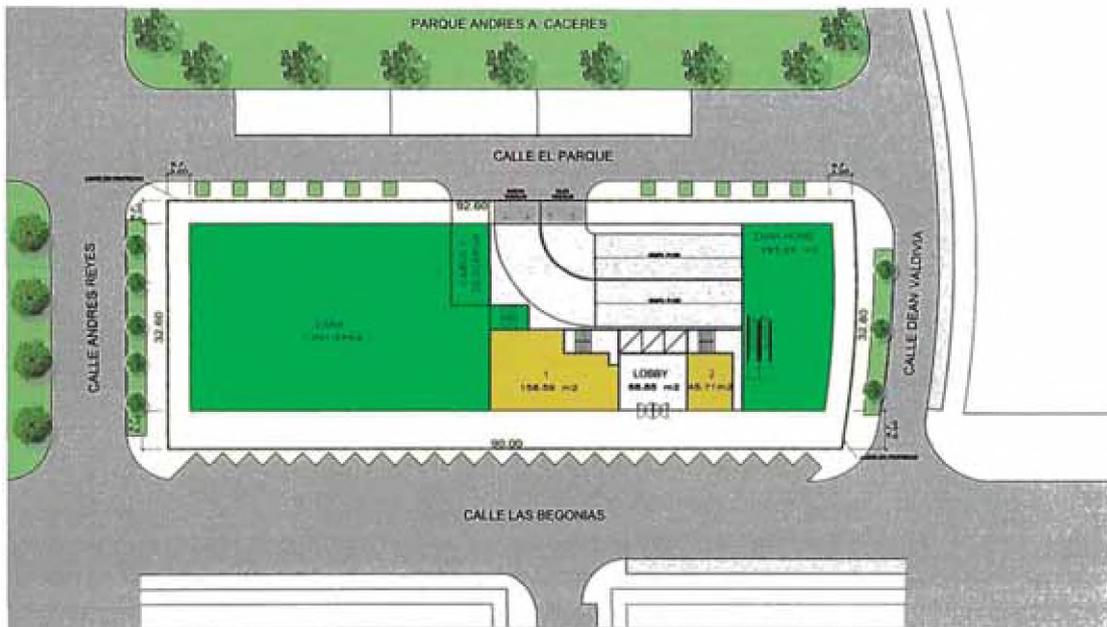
Planta del primer Nivel del edificio, Fuente Propia.
